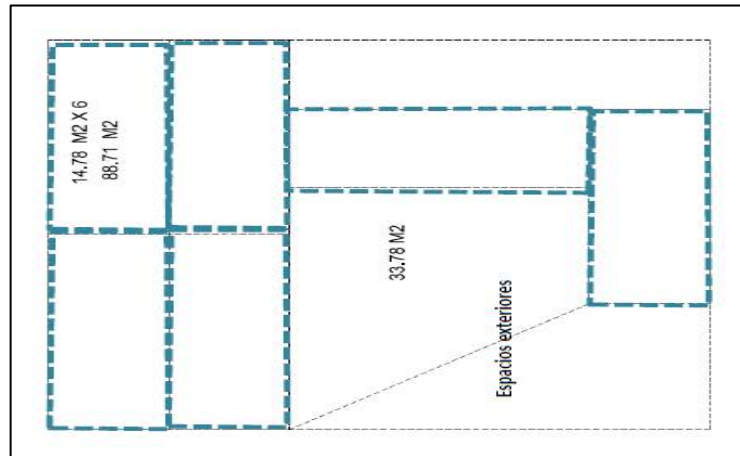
Plano de distribución de contenedores diseño planta de proceso congelado.
